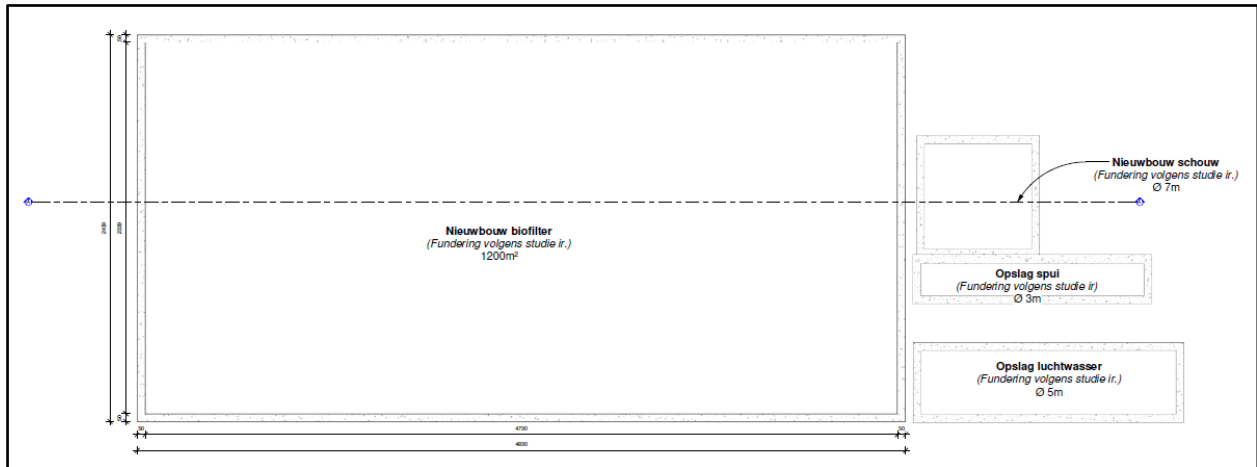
Funderingsplan nieuwbouw loads B en biofilter⁸
